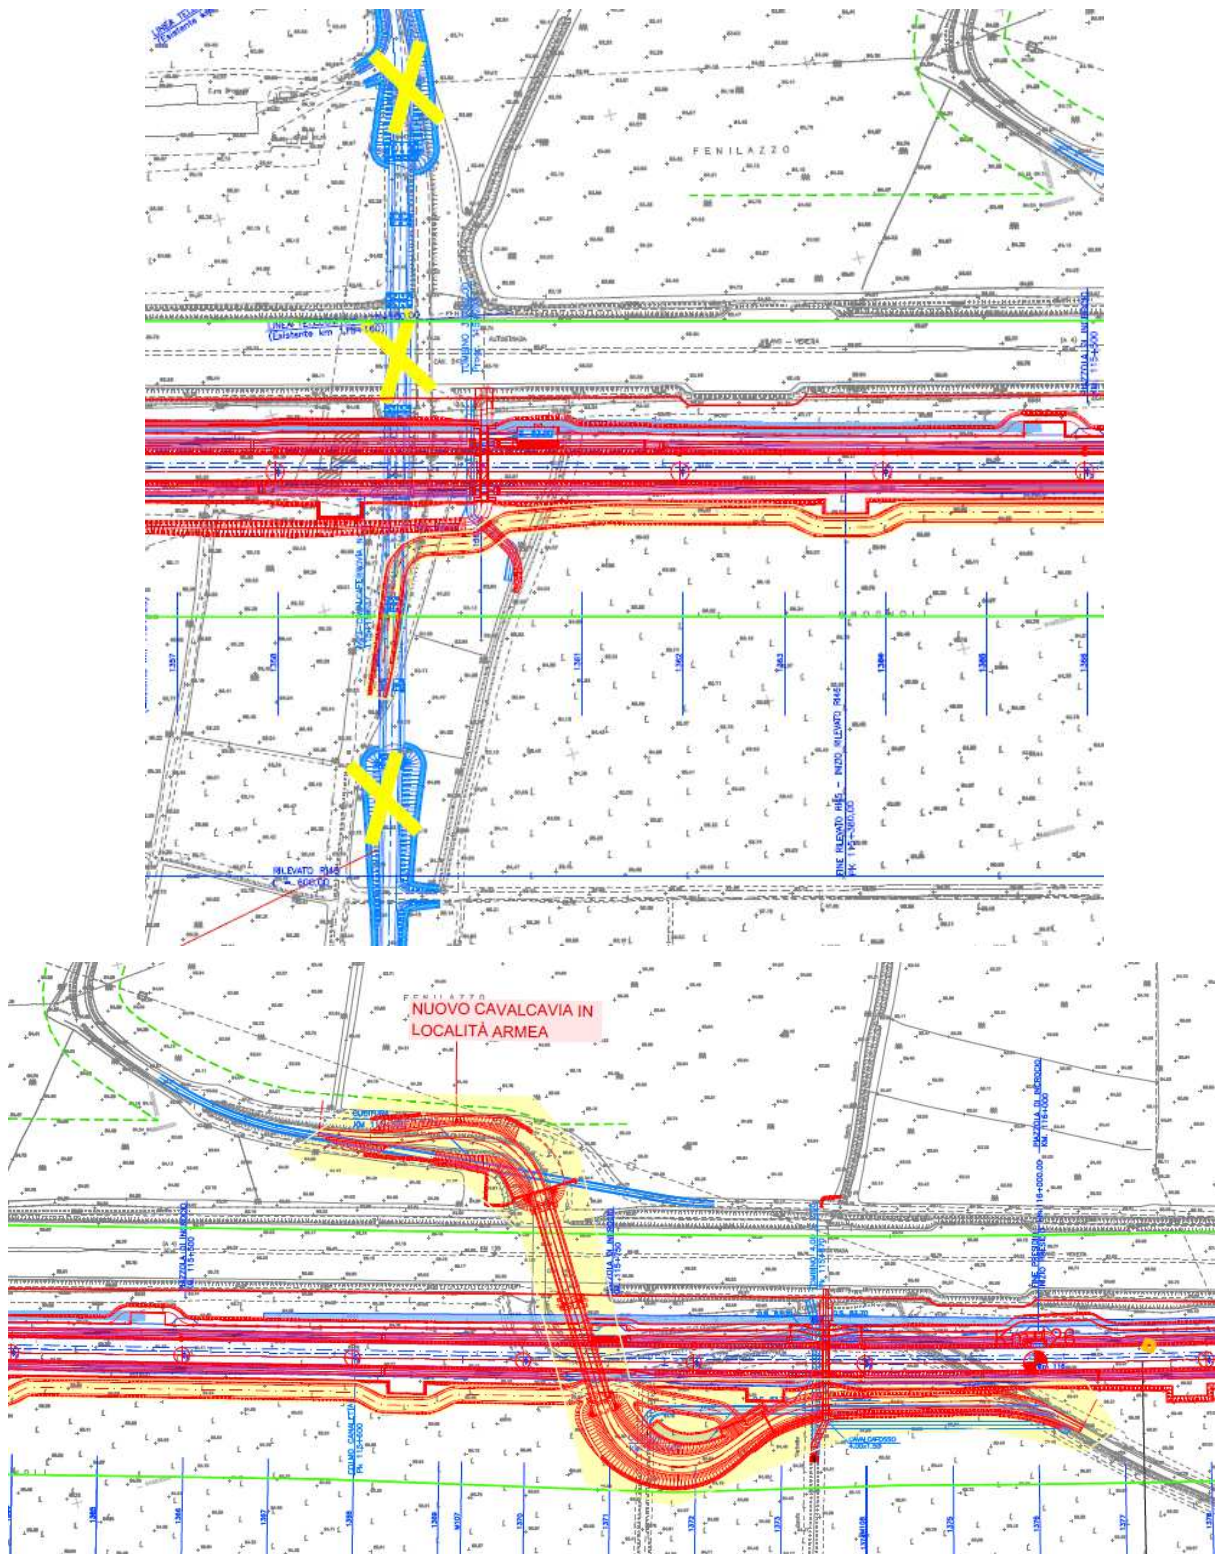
Stralcio sovrapposizione PD e PE (in blu progetto definitivo, in rosso progetto esecutivo, in giallo area variante, in verde limite corridoio urbanistico)
